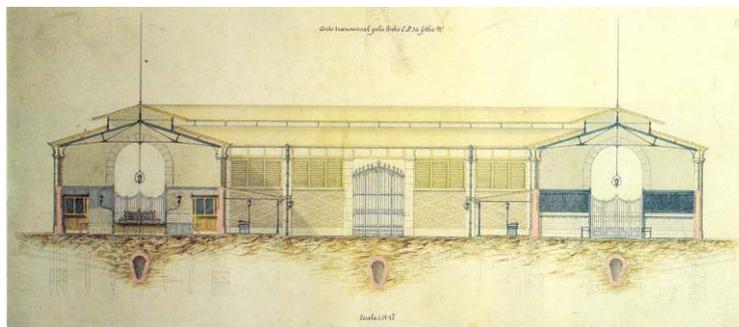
Corte transversal do mercado: vista para Norte
